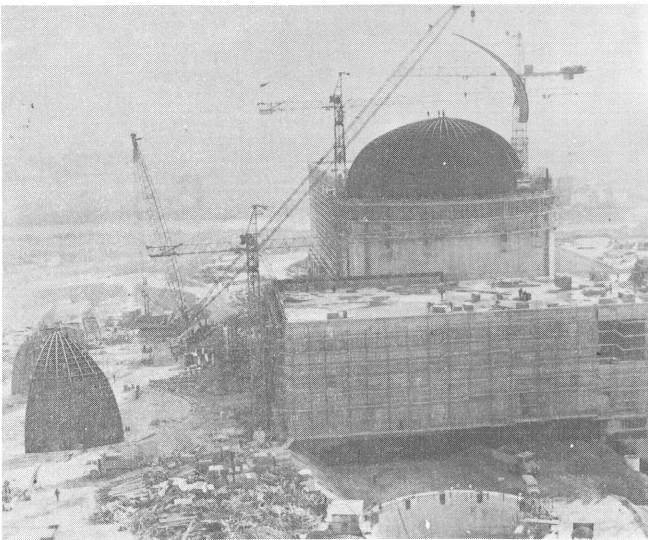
Vista general del muro en construcción del edificio de contención. Puede verse el encofrado trepante, la colocación de vainas verticales y horizontales, y la armadura.
